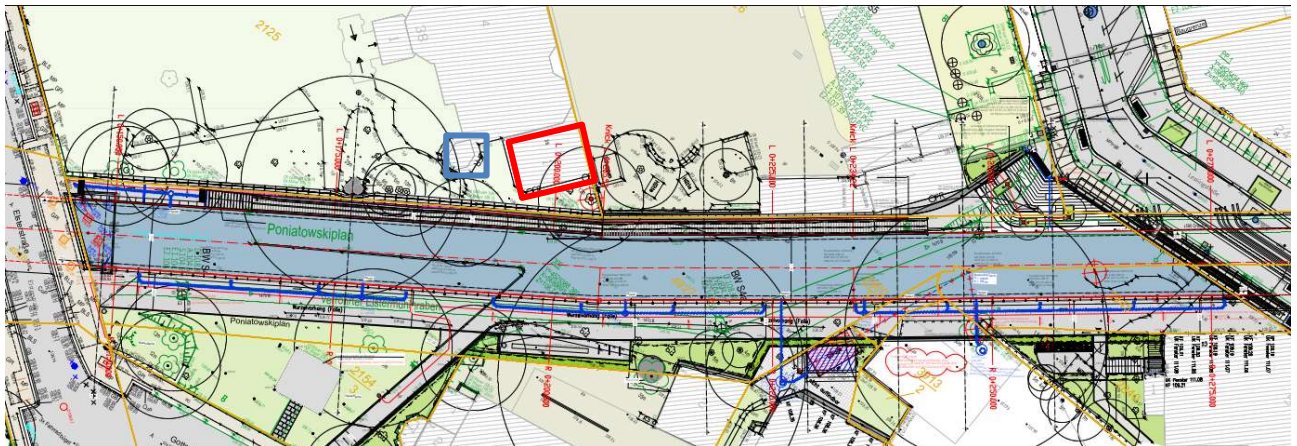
Lageplan Objektplanung [U1] mit Darstellung des Anbaus (rot) und Erker (blau) auf dem Grundstück der Elsterstraße 38
